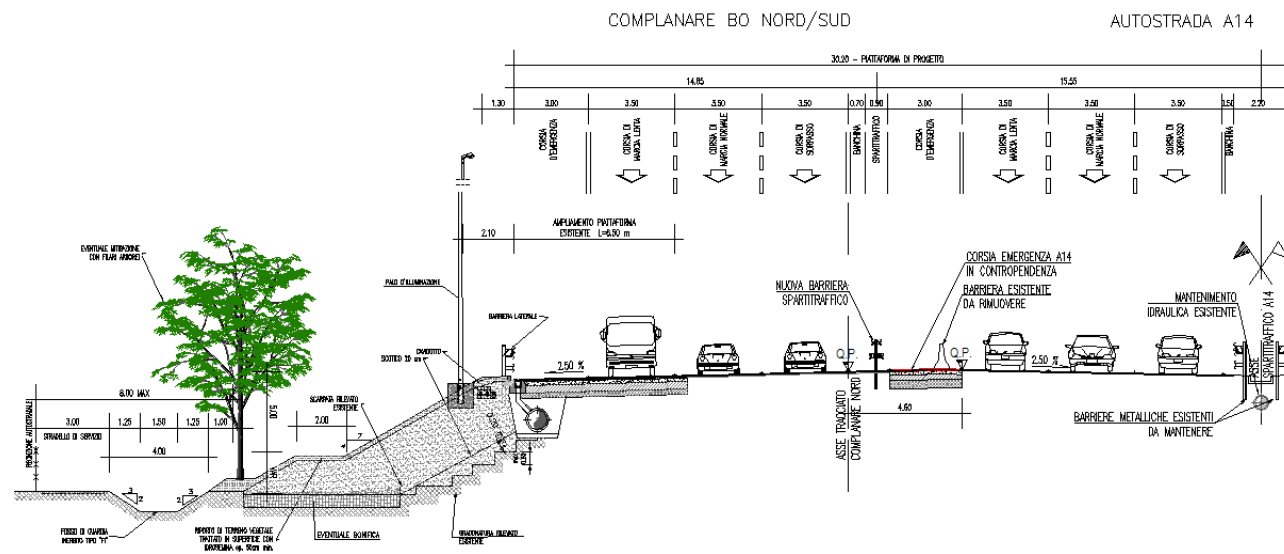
Semi Sezione Tipo (fonte: relazione tecnico-illustrativa progetto preliminare)
